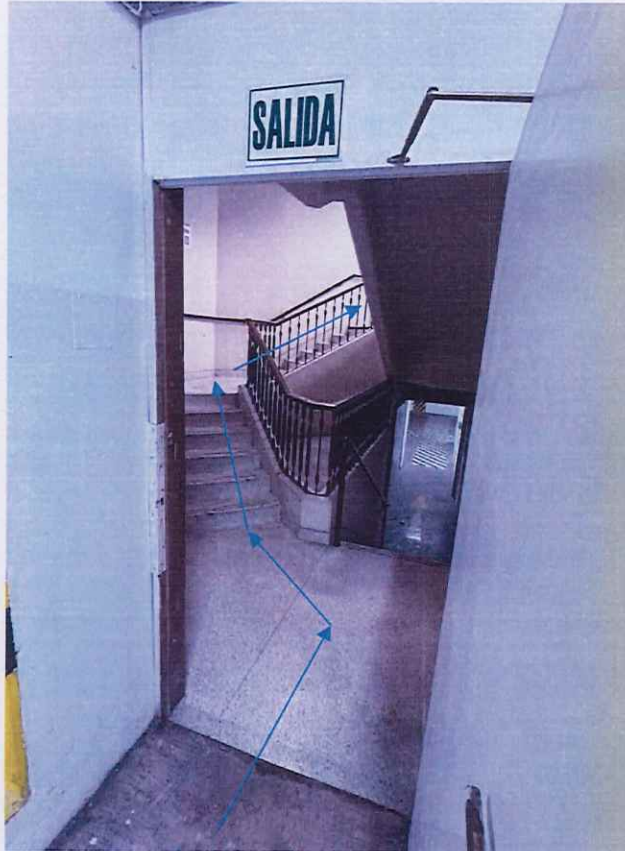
Foto propia de la escalera de acceso al semisótano.
